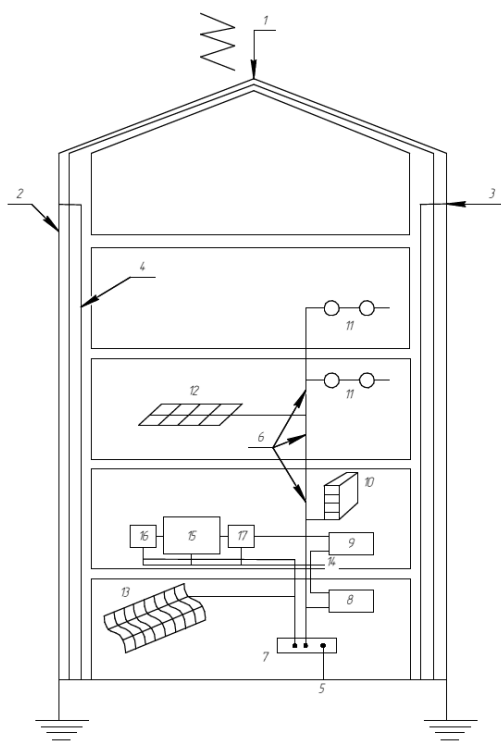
Заземляющее устройство здания: 1 – молниеприемник; 2 – молниезащитные спуски; 3 – уравнивающие проводники; 4 – стальной каркас или арматура железобетонного каркаса здания; 5 – фундаментный заземлитель или арматура железобетонных фундаментов здания; 6 – система электропитания; 7 – главный заземляющий зажим; 8 – главная распределительная шина; 9 – система непрерывного питания; 10 – распределительный щит; 11 – выключатель; 12 – уравнивающая сетка; 13 – металлические кабель-проводы; 14 – местная система уравнивания потенциалов; 15 – информационно-технологическое оборудование; 16 – телефон; 17 – электронные системы здания и квартир
